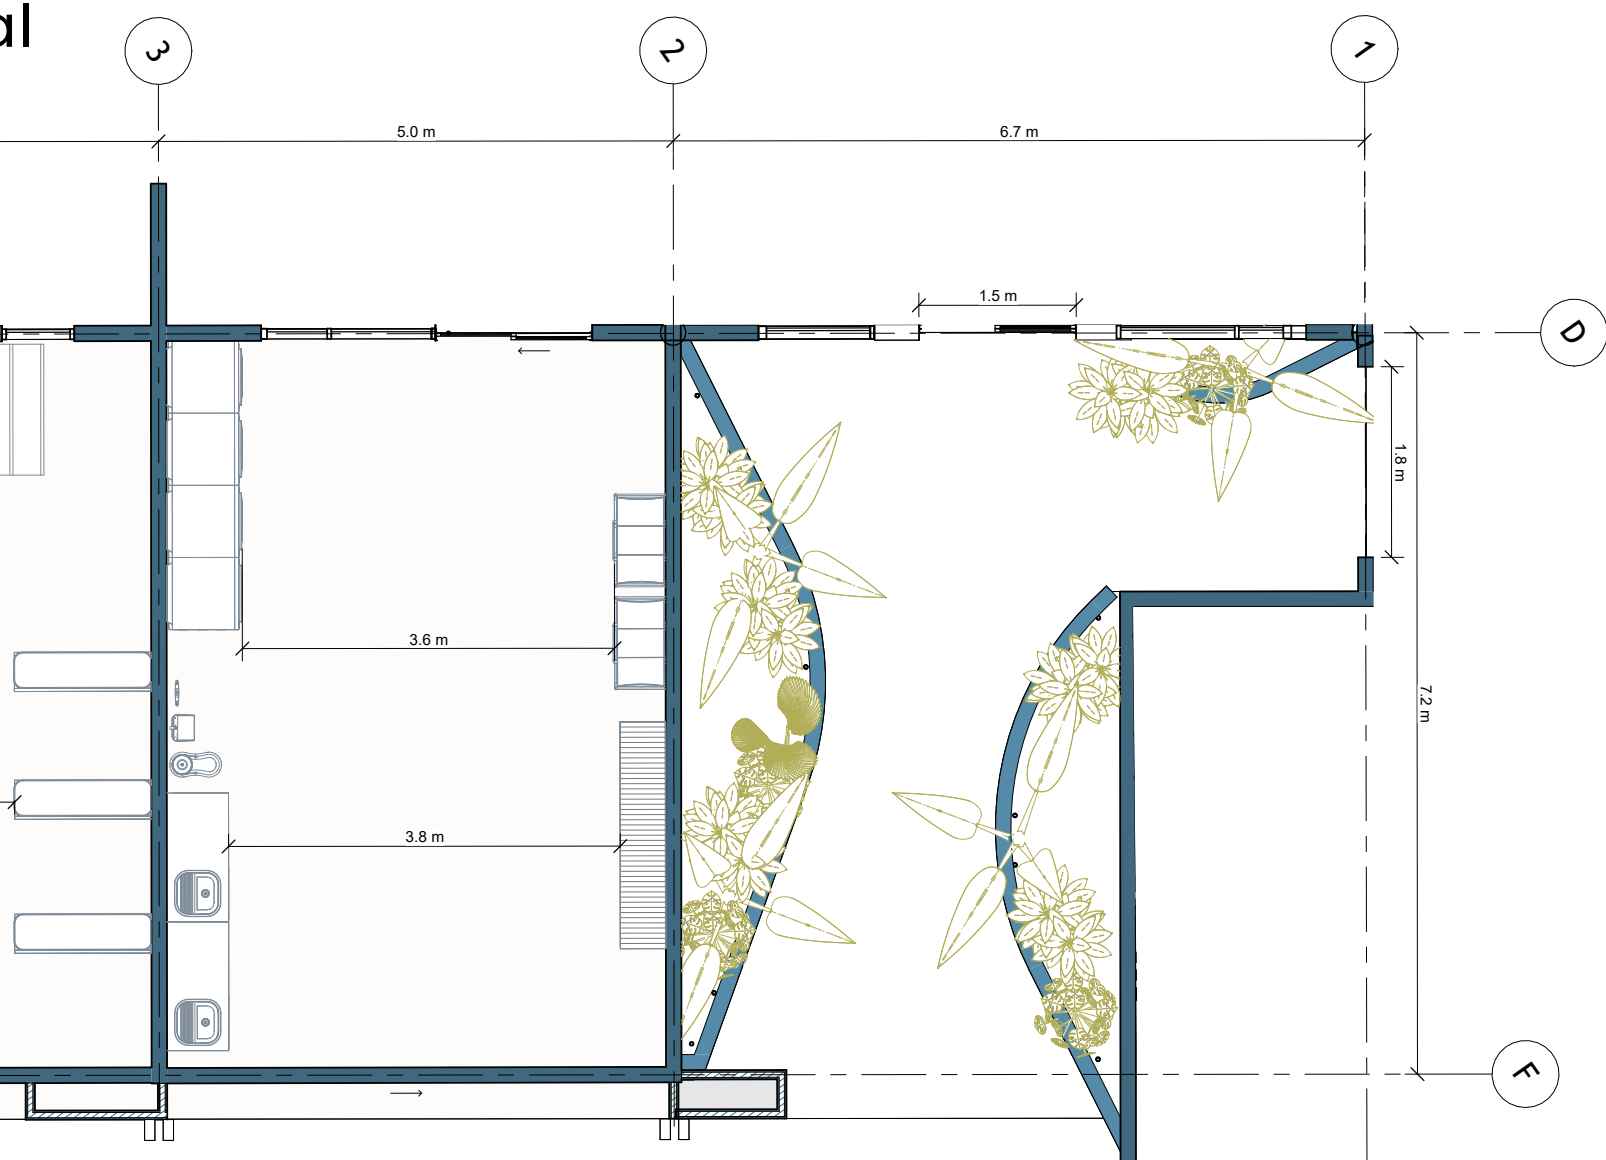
Planta arquitectónica de espacios sociales. Fuente: Elaboración propia.
